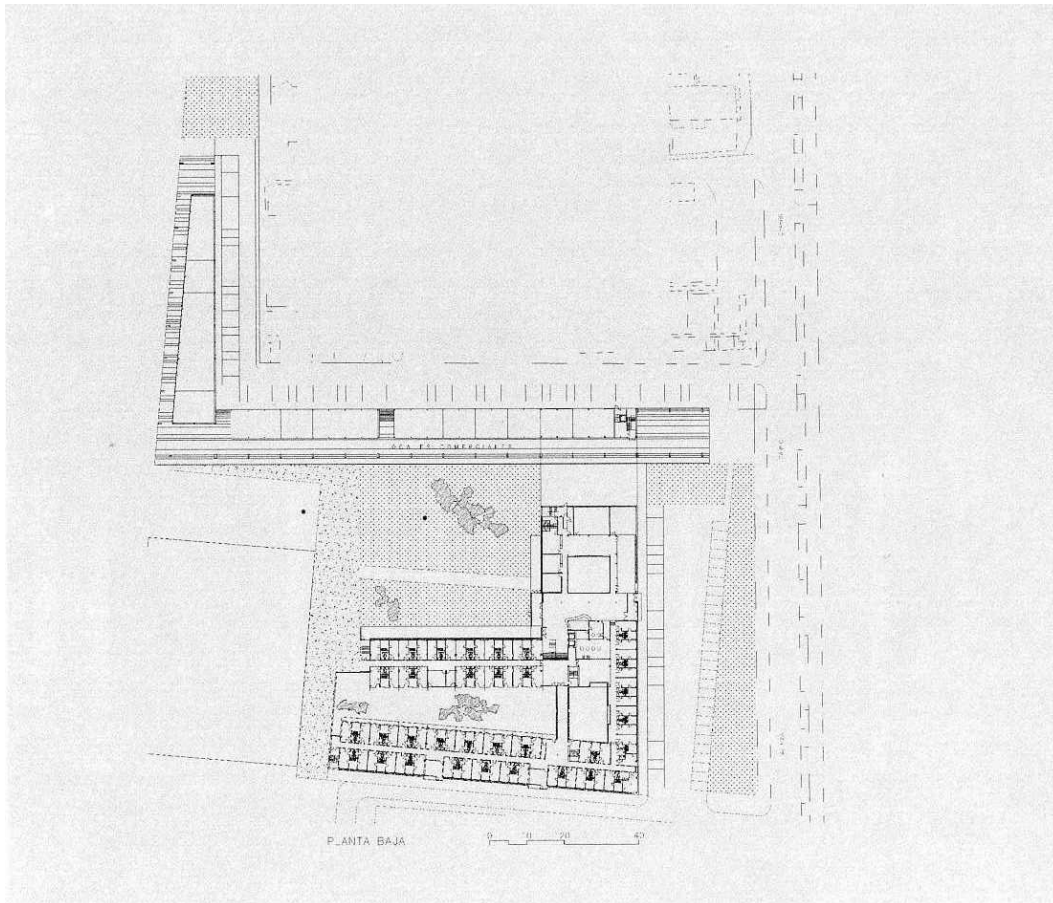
R. U. Colegio de Cuenca y locales comerciales: planta baja.
